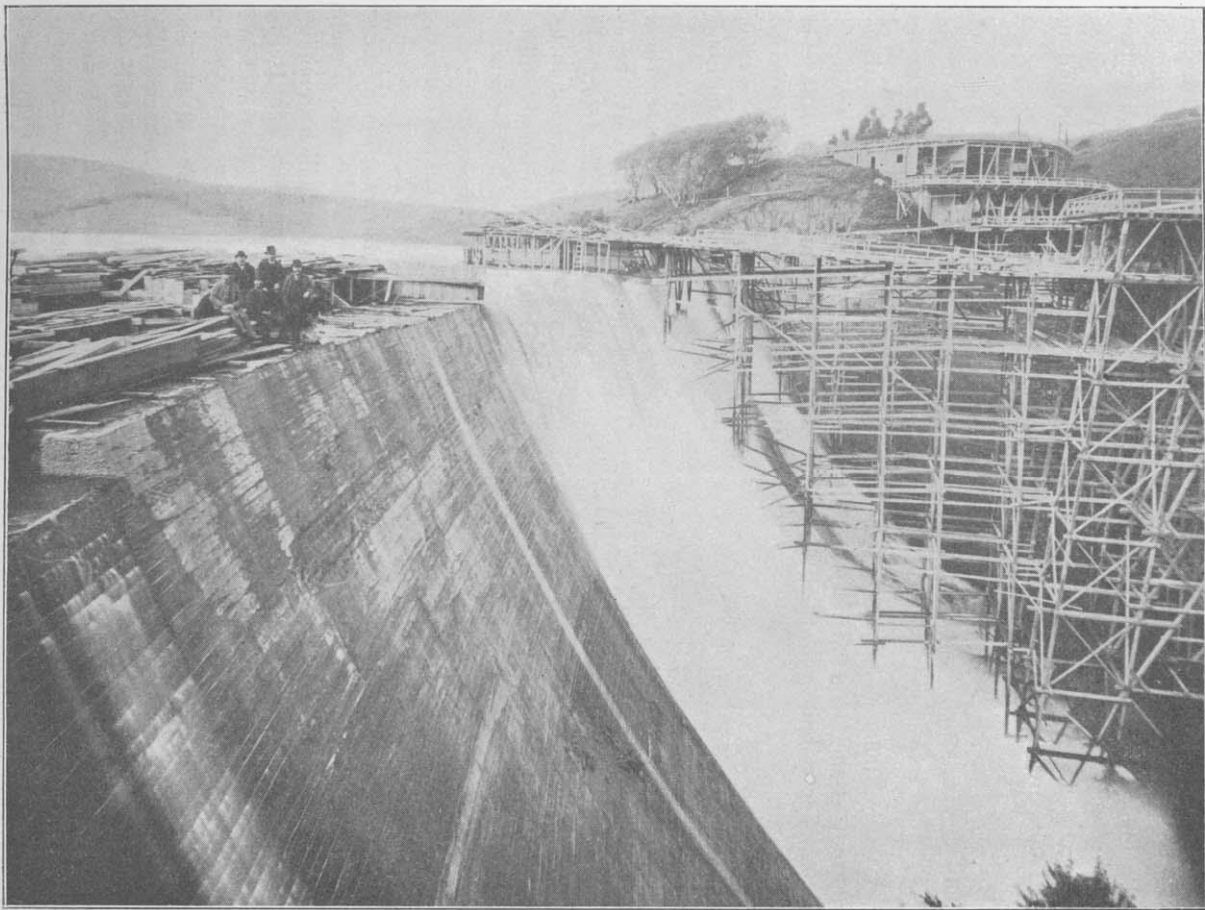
Mauer von Crystal Springs. Luftseitige Ansicht. Rechts die Betonbereitungsanlage nebst Transportgerüsten.
